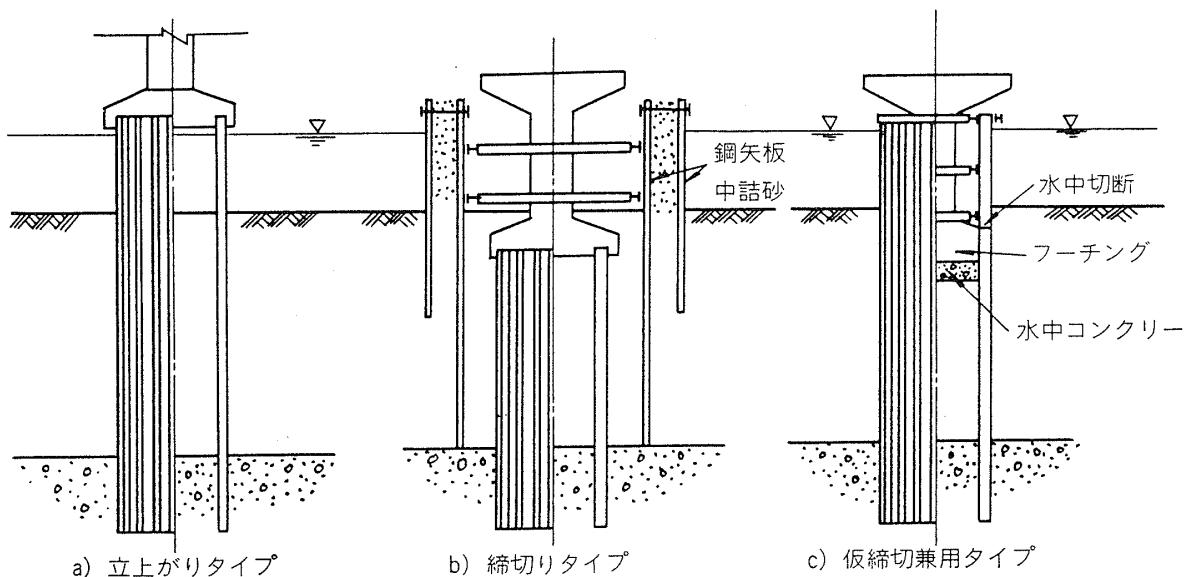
矢板式基礎の施工法による分類¹⁸⁶⁾
